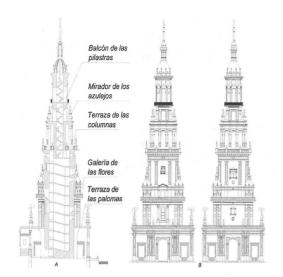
Levantamiento de las torres: (a)Sección tipo con indicación de las terrazas; (b)Alzados tipo (Fuente documental propia)
